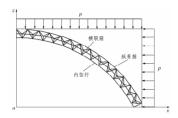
Calculation model of reinforced shell 图 1 钢筋网壳计算模型图
